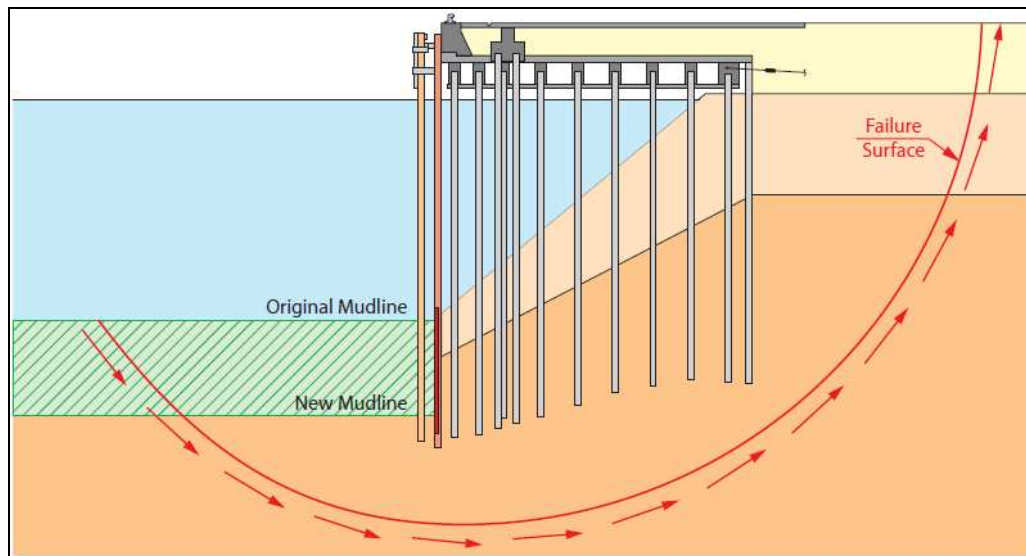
Possível modo de rotura geotécnica num cais [64].
